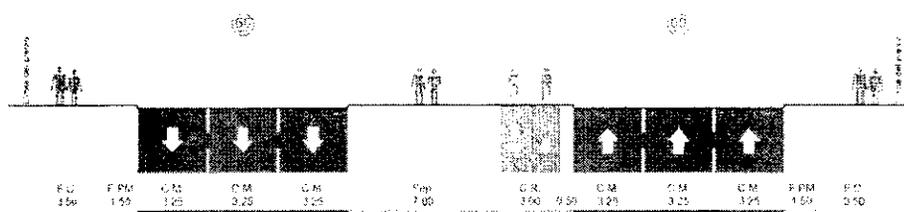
Sección vial tipo - Avenida 1ro de Mayo
